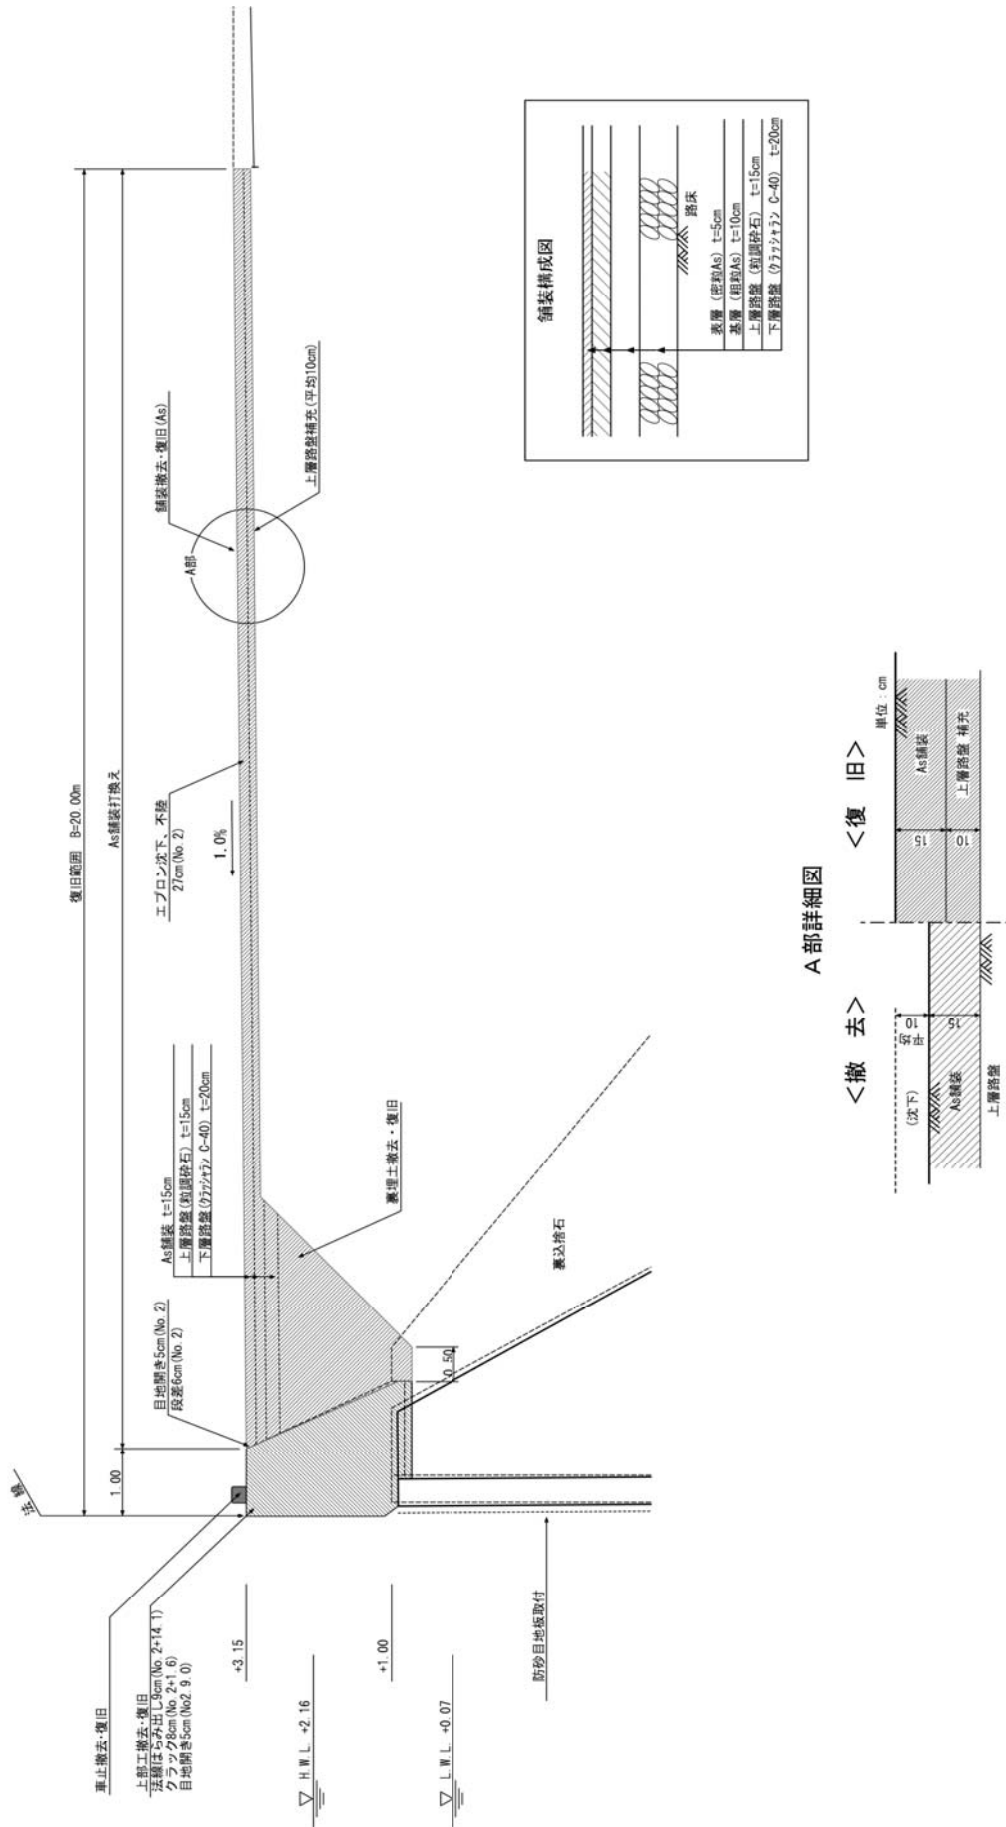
(b) 箱崎埠頭-12m 岸壁の被災・復旧標準断面図
